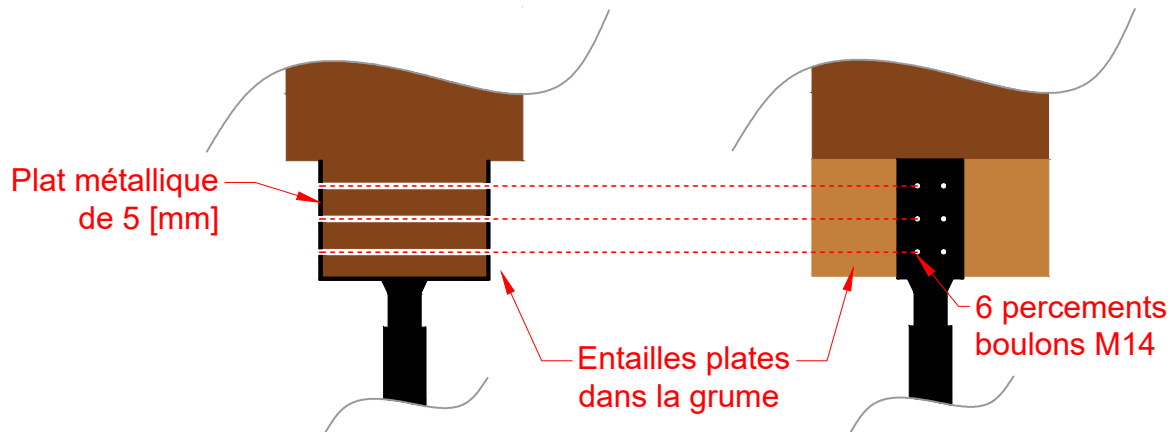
Assemblage de pied des poteaux de la structure haute.
